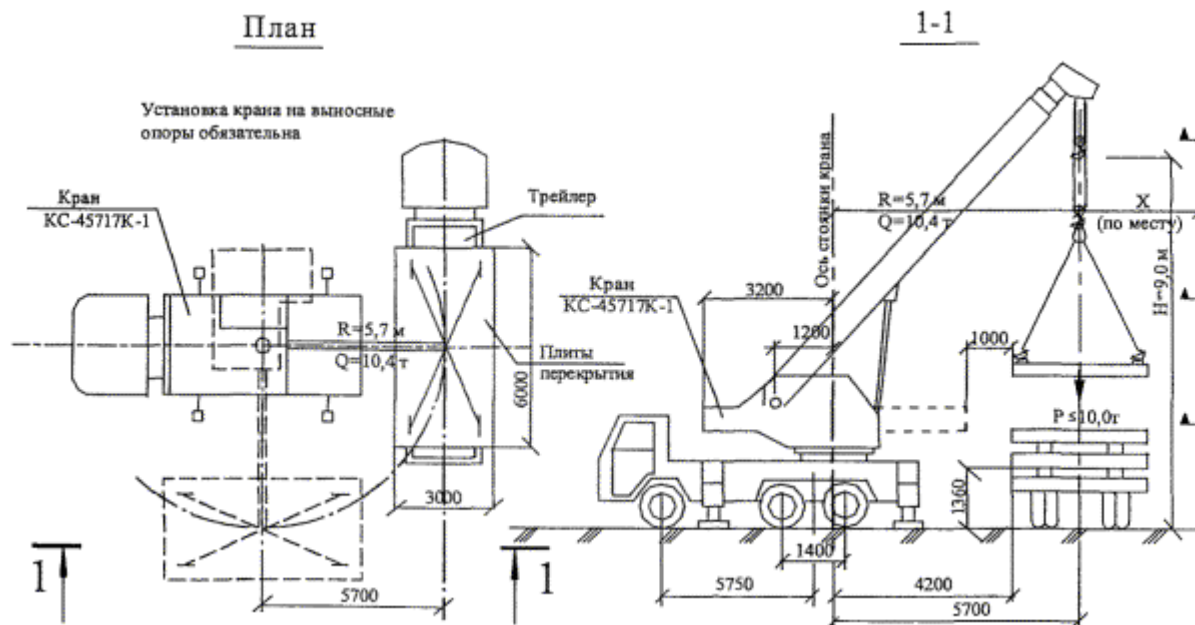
Погрузка и разгрузка плит перекрытия краном КС-45717К-1
